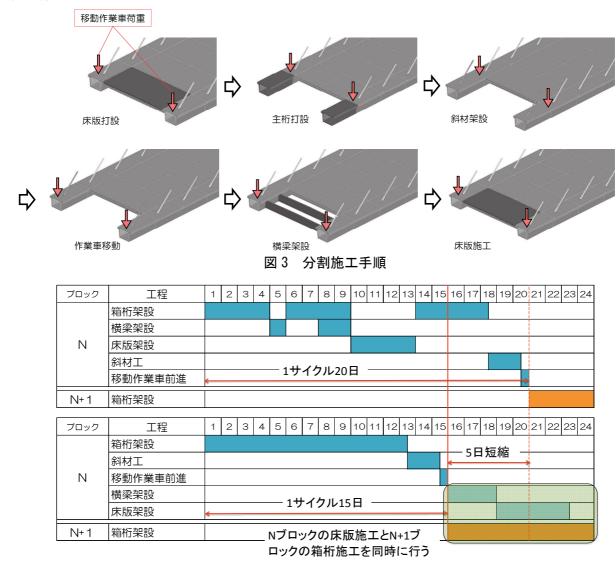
施工工程比較(上:全断面一括施工 下:分割施工)
